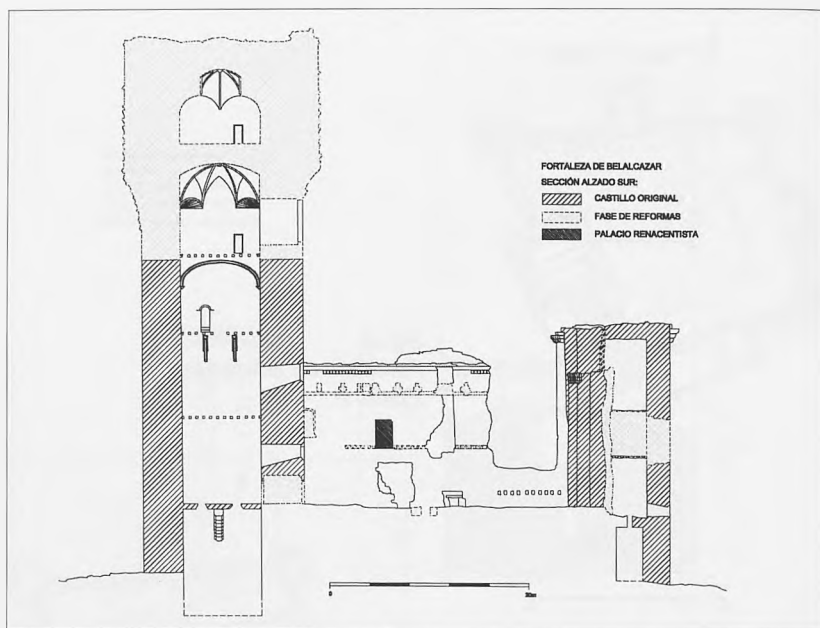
Fortalezuela de Belalcázar. Sección alzado sur.
